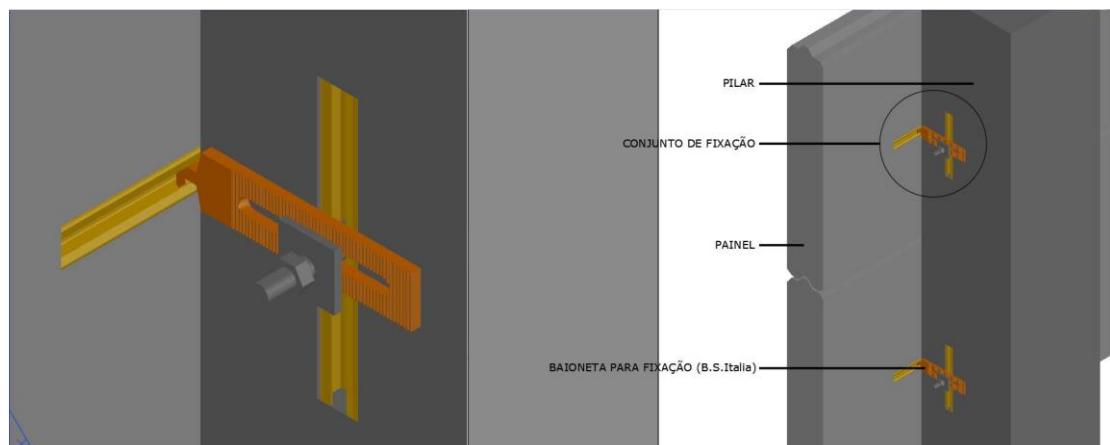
Pormenor de fixação de um painel pré-fabricado com um pilar pré-fabricado (José Rui Pinto, 2021)
